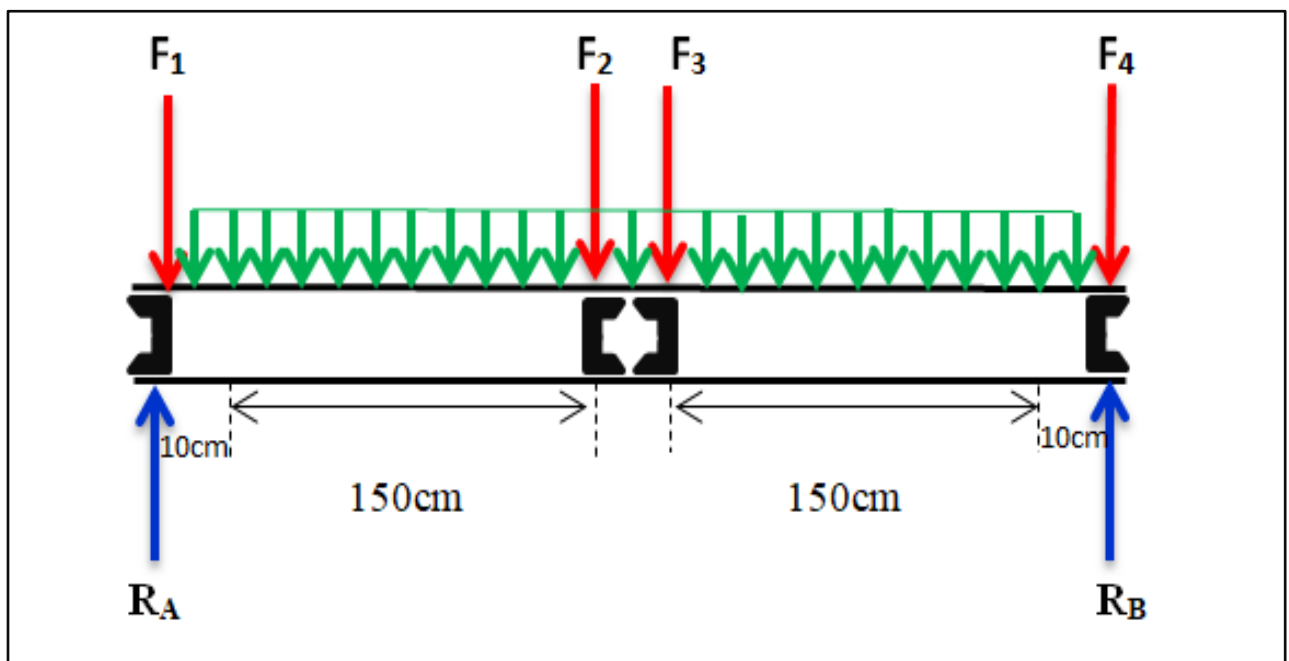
Coupe transversal de disposition des limons sur la poutre palière
